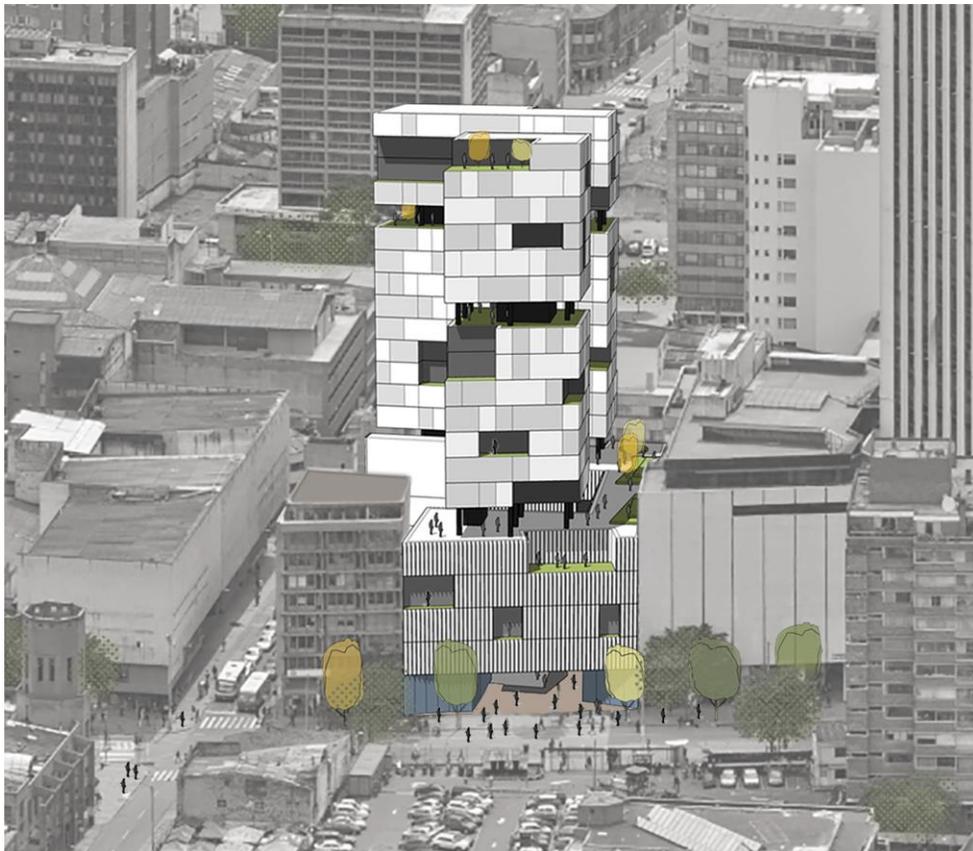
Idea básica proyectual, fotomontaje: kra. 7 cl. 24. (Rudolf)
